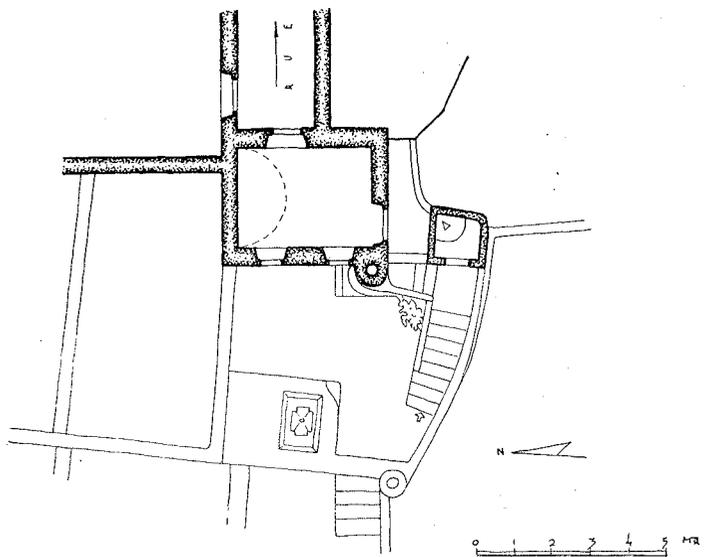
Maison à Ia (Santorin). Plan du 1<sup>er</sup> étage
